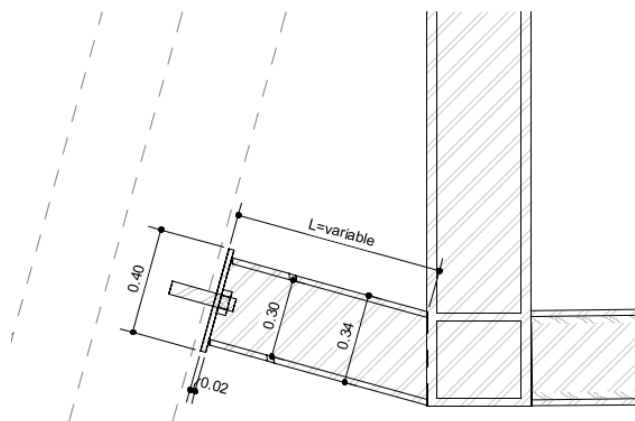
Extrait cahier de plans : Représentation de principe de l'appui inférieur
